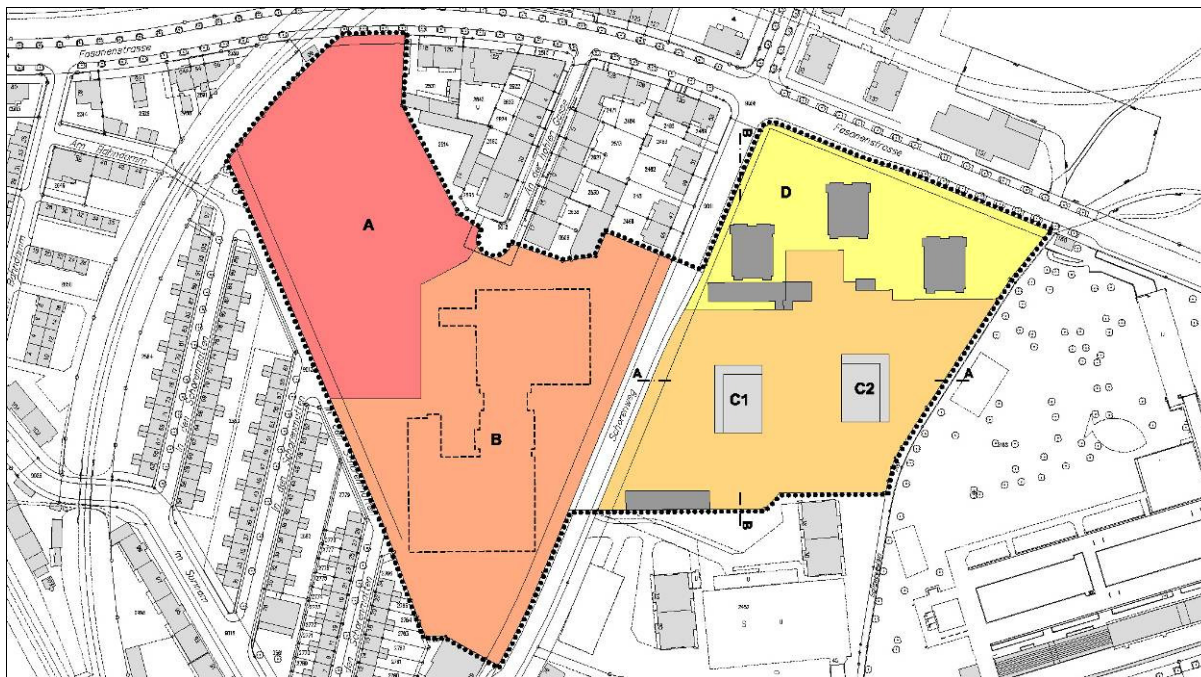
Neuer Bebauungsplan, Plan Nr. 13'329 Areal Schoren, Situation. (ohne Massstab, Plan genordet)
